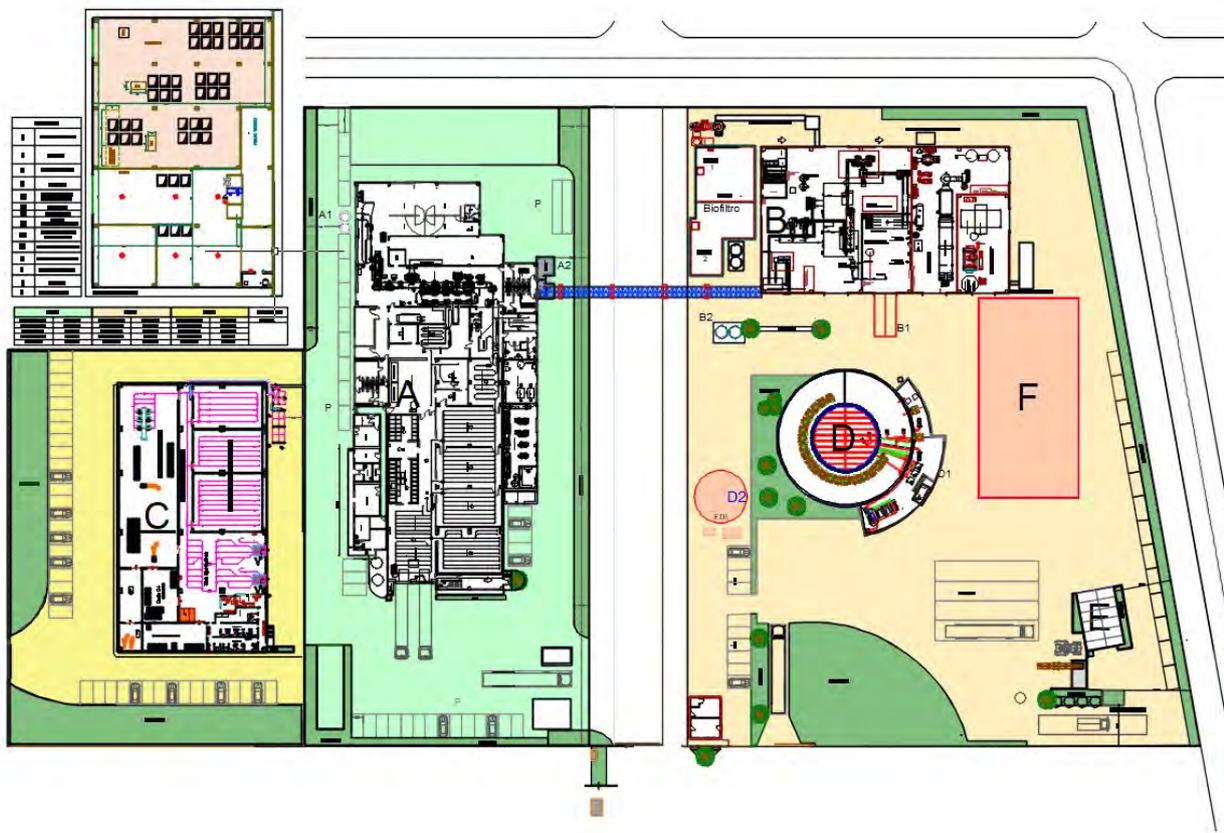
layout dello stabilimento come da planimetria dello stato attuale
